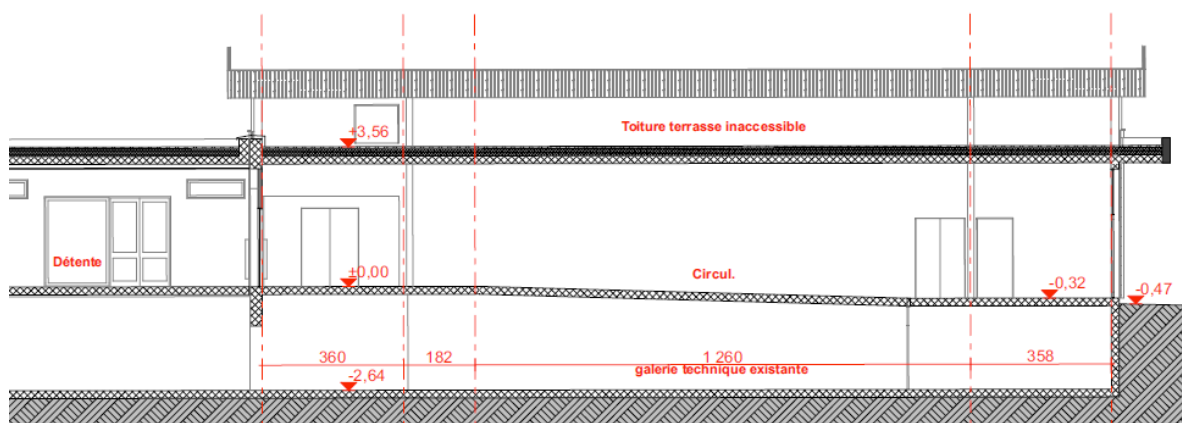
Coupe DD longitudinale partielle du bloc B du bâtiment F (sans échelle)
